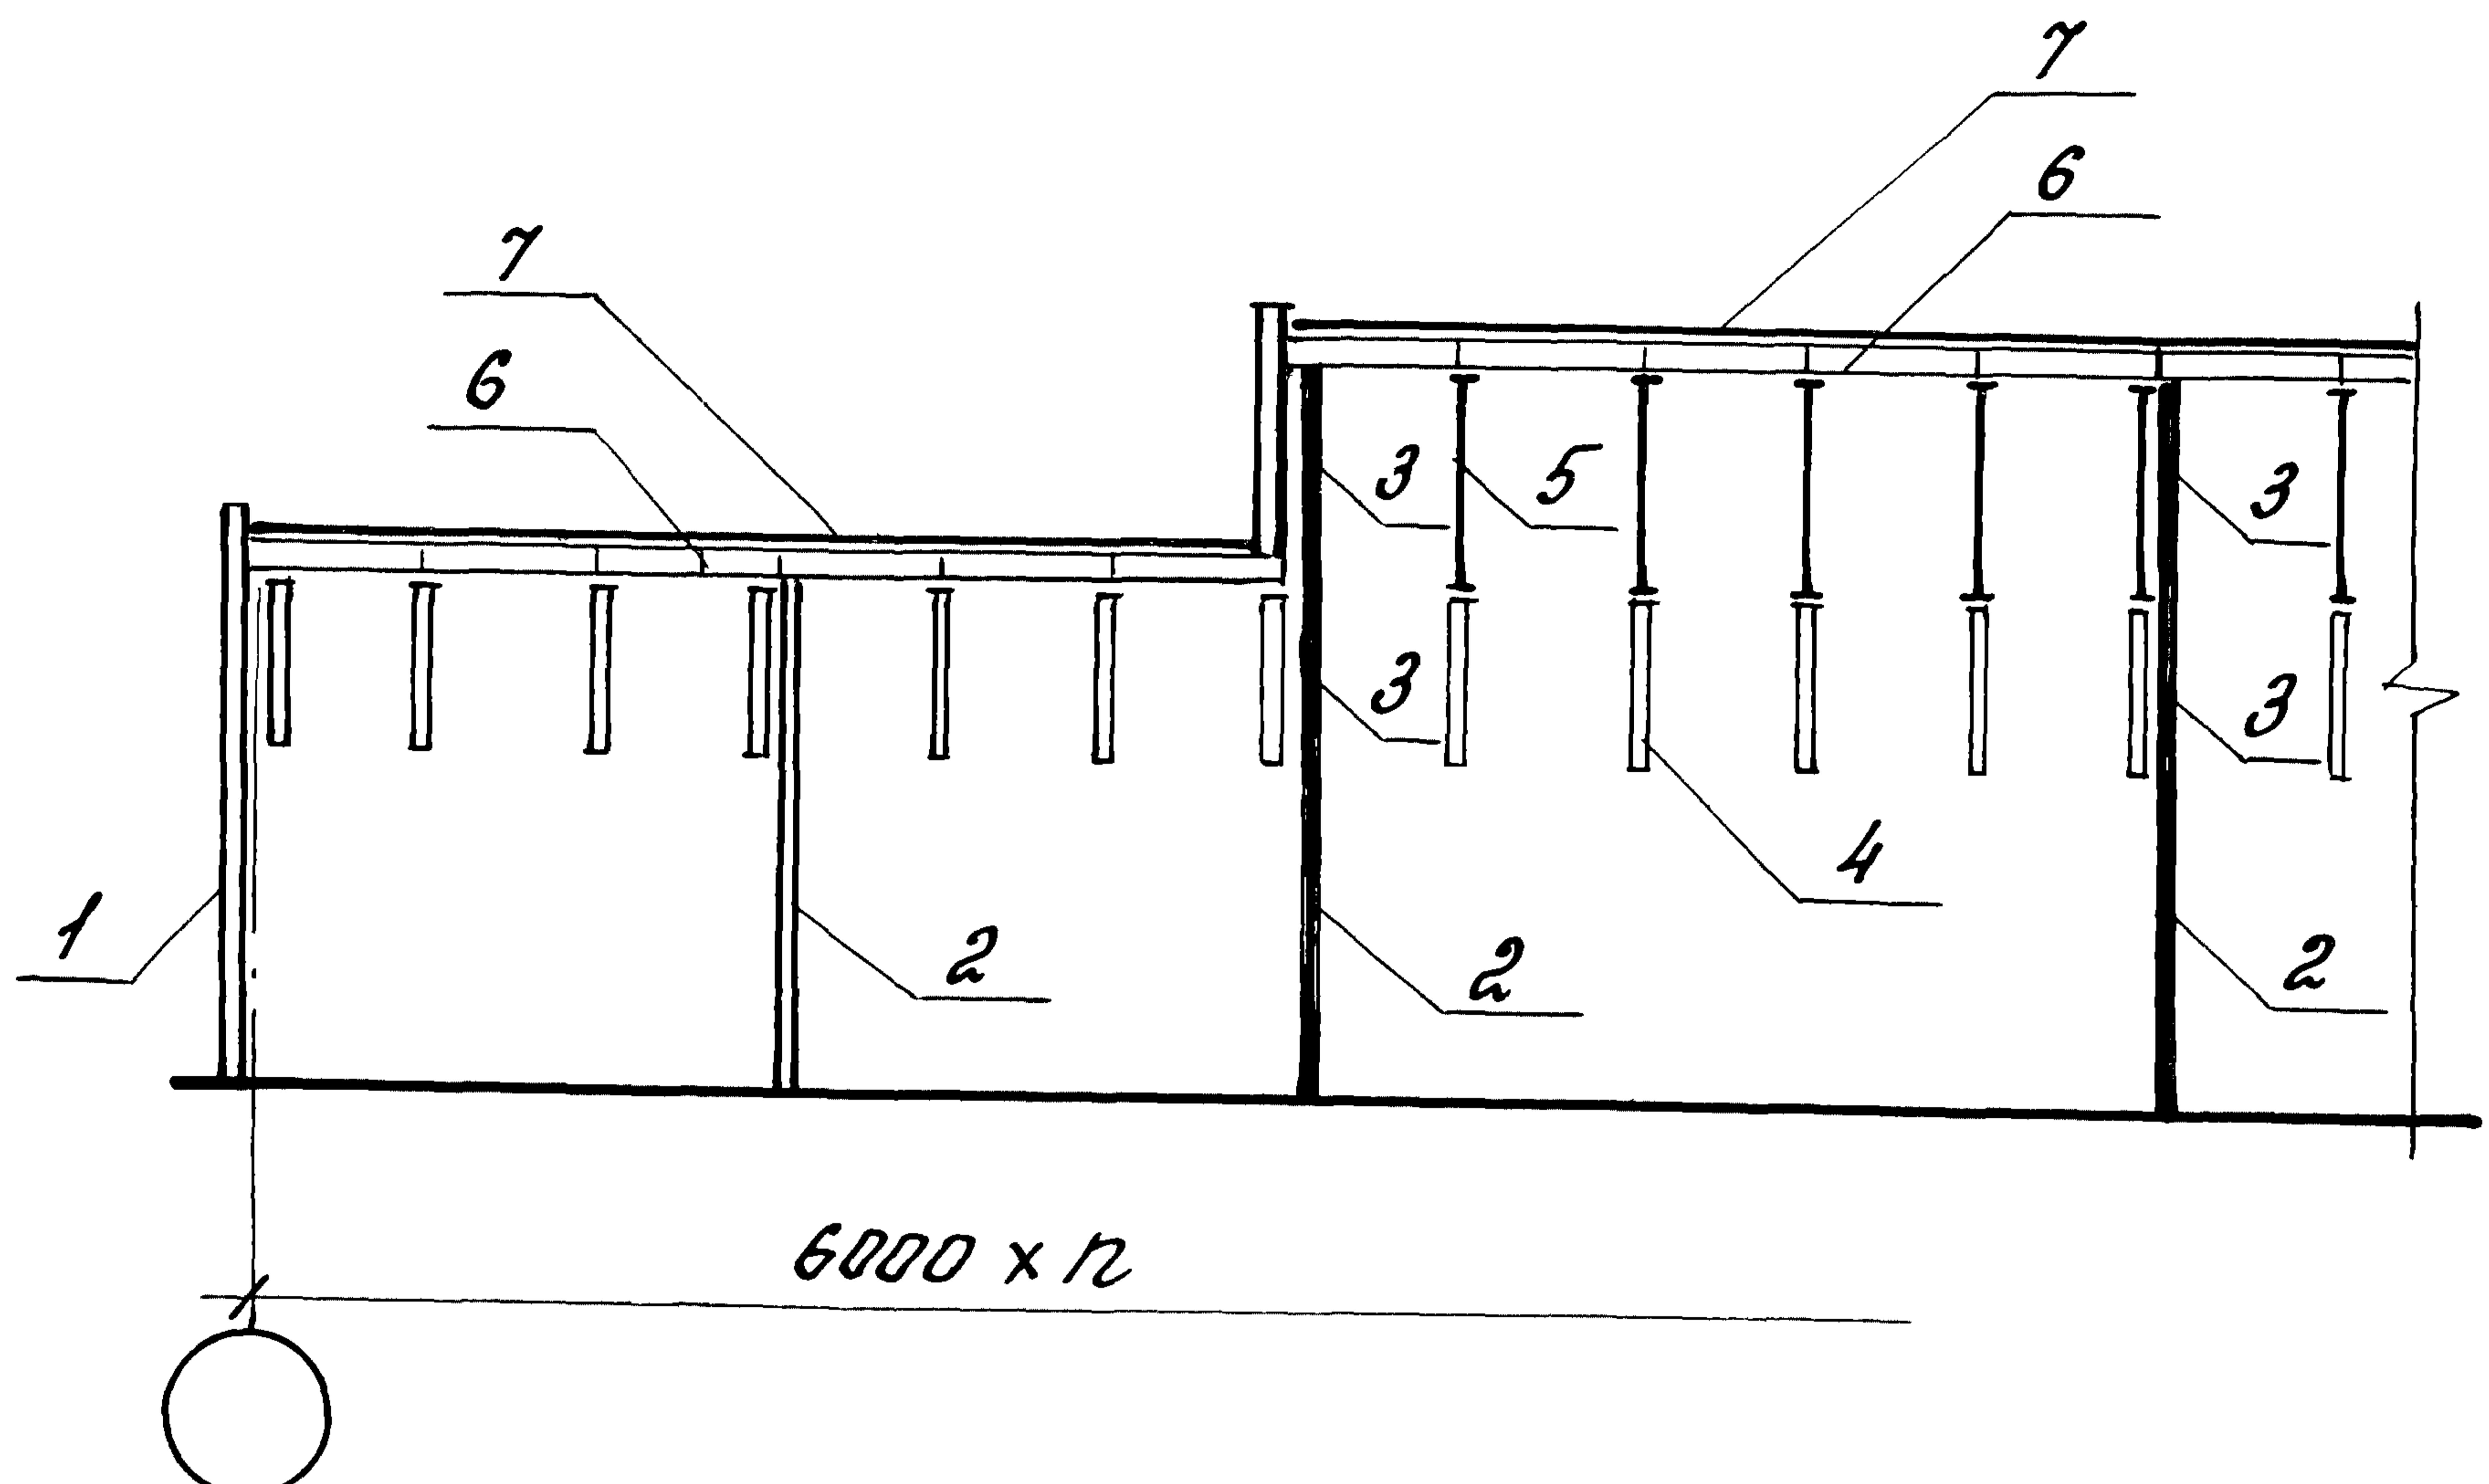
Пример расположения противопожарных перегородок в разрезе здания с ограждающими конструкциями стен и покрытий из негорючих материалов
